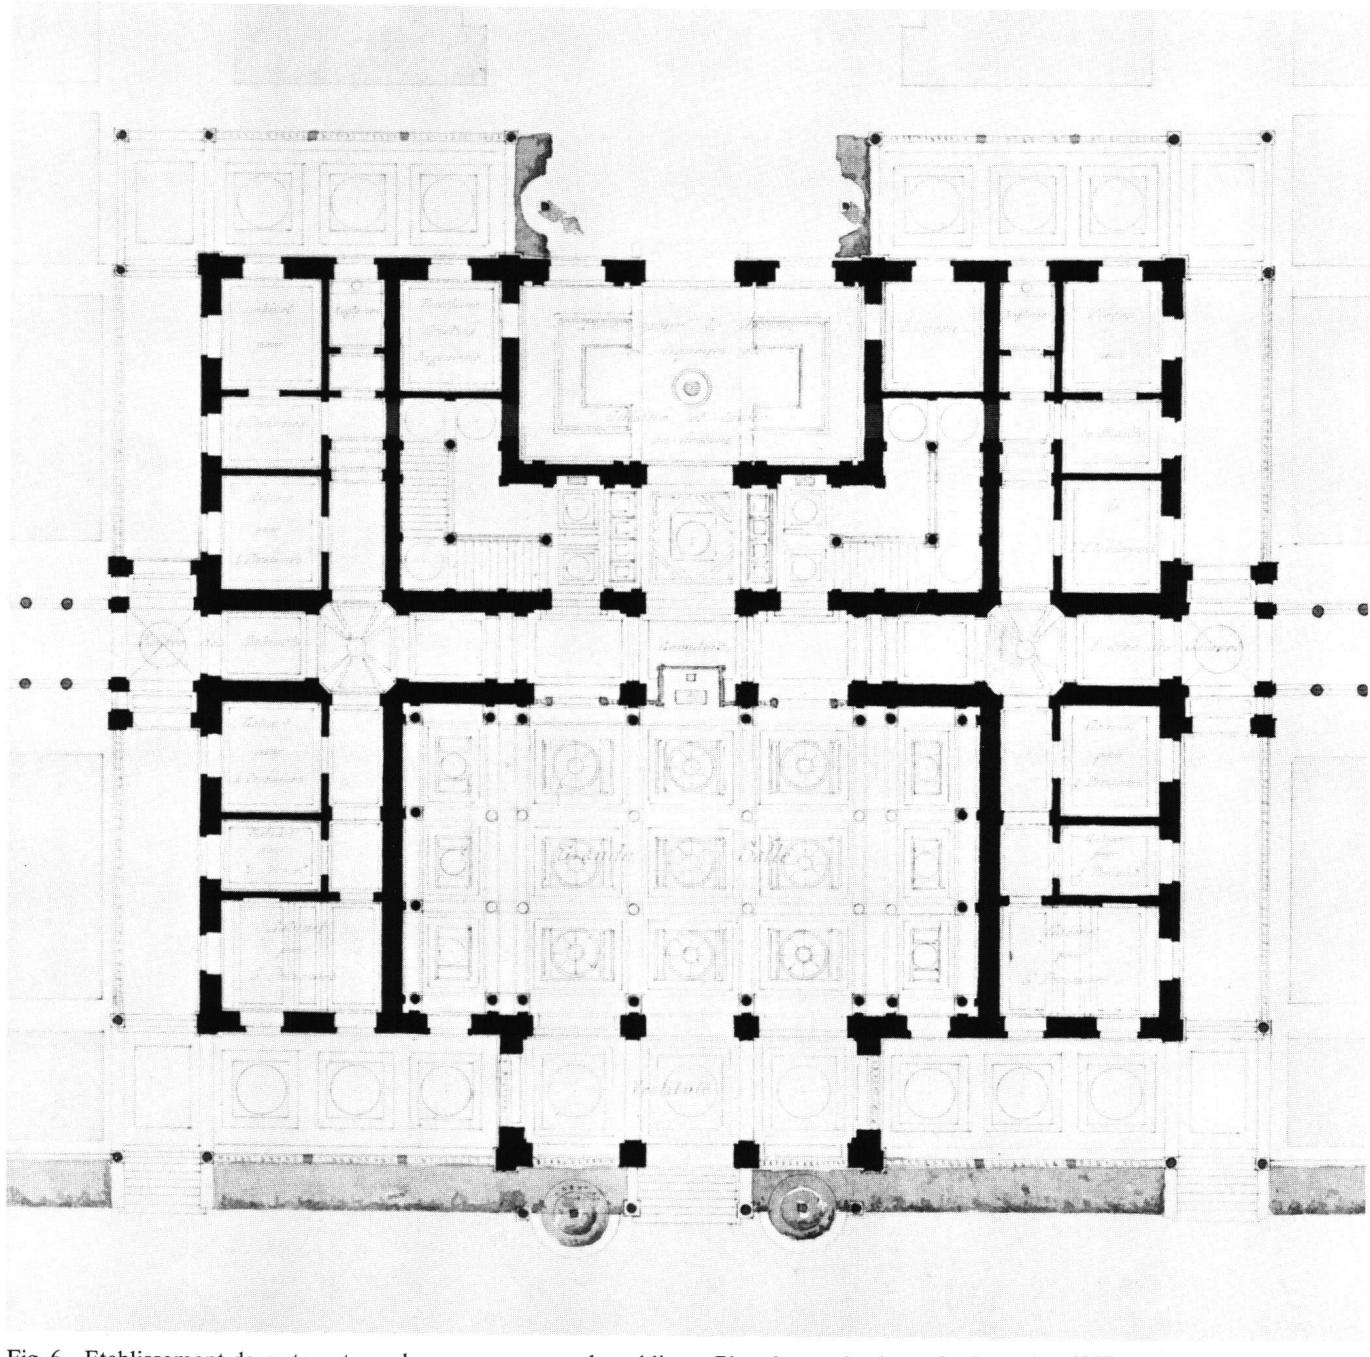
Etablissement de restaurateur, dans une promenade publique. Plan du rez-de-chaussée, 7 octobre 1857.
